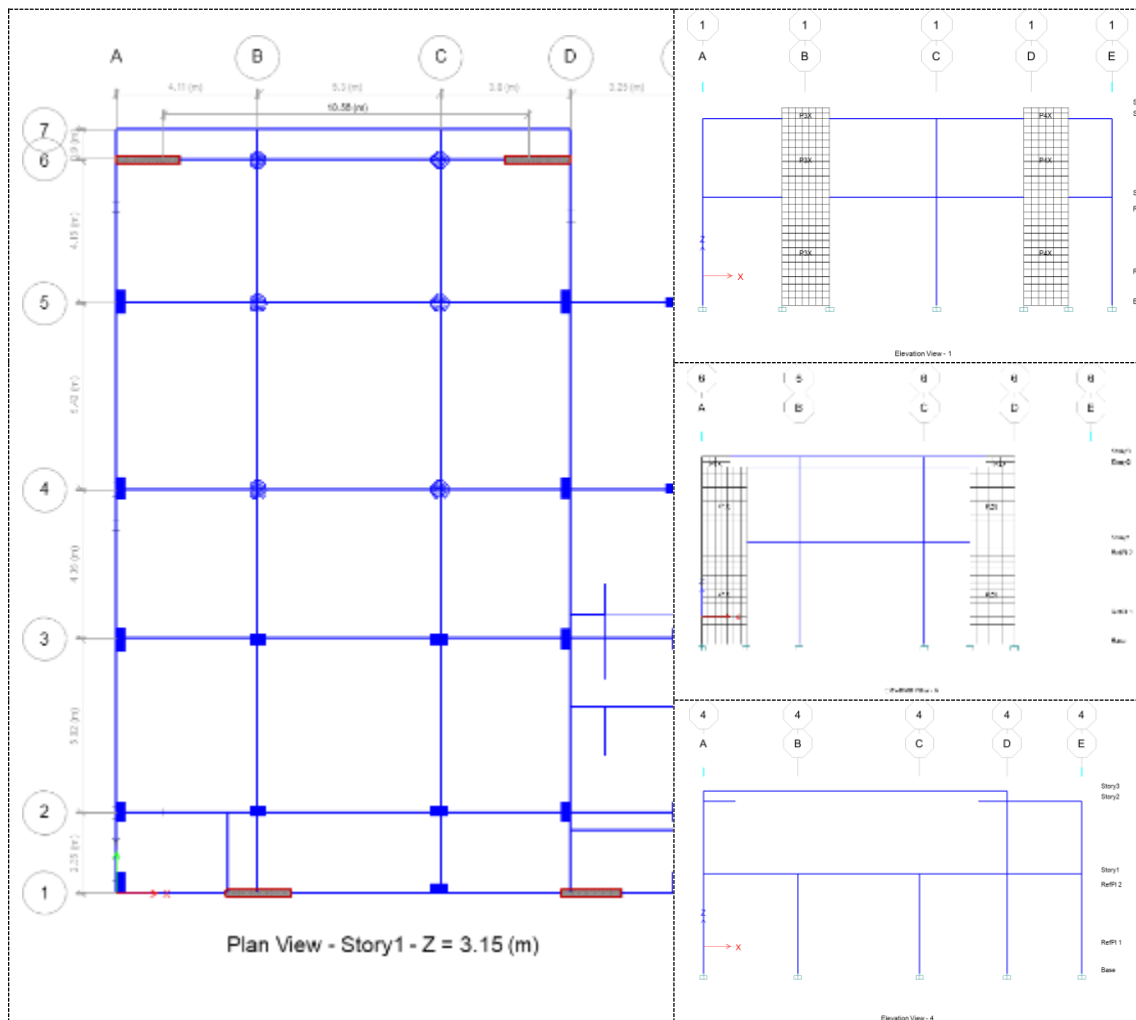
Modulo III, Propuesta 2, muros de concreto armado
